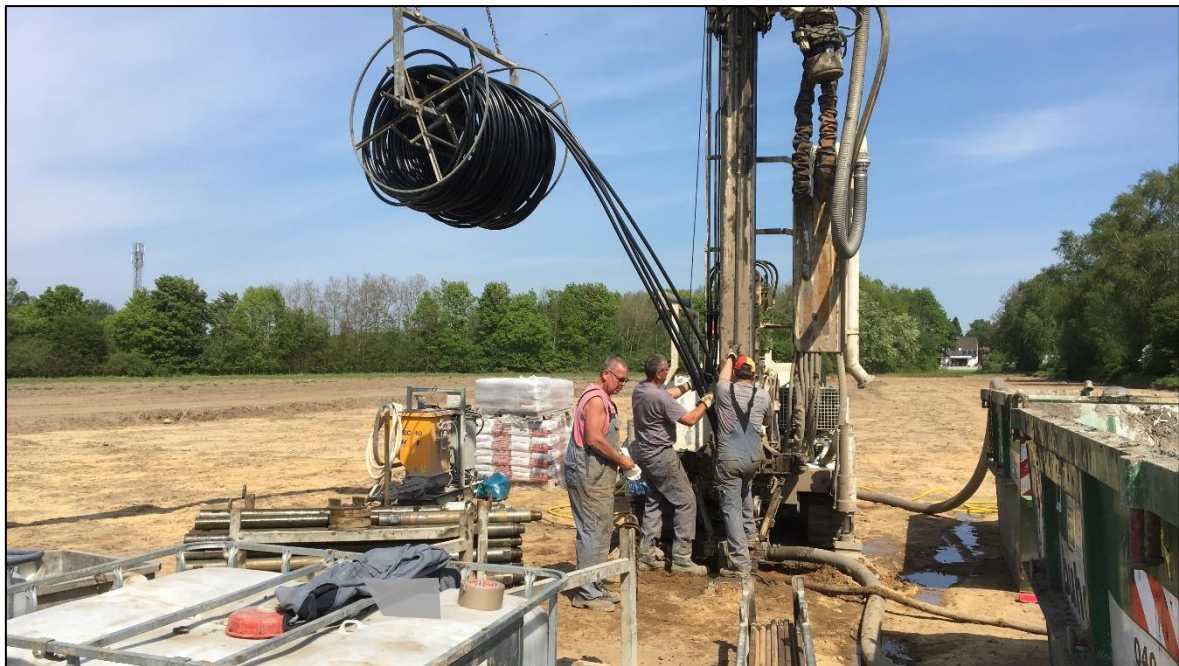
Einbau einer Erdwärmesonde am Standort Reinbek (Quelle: HSW)
